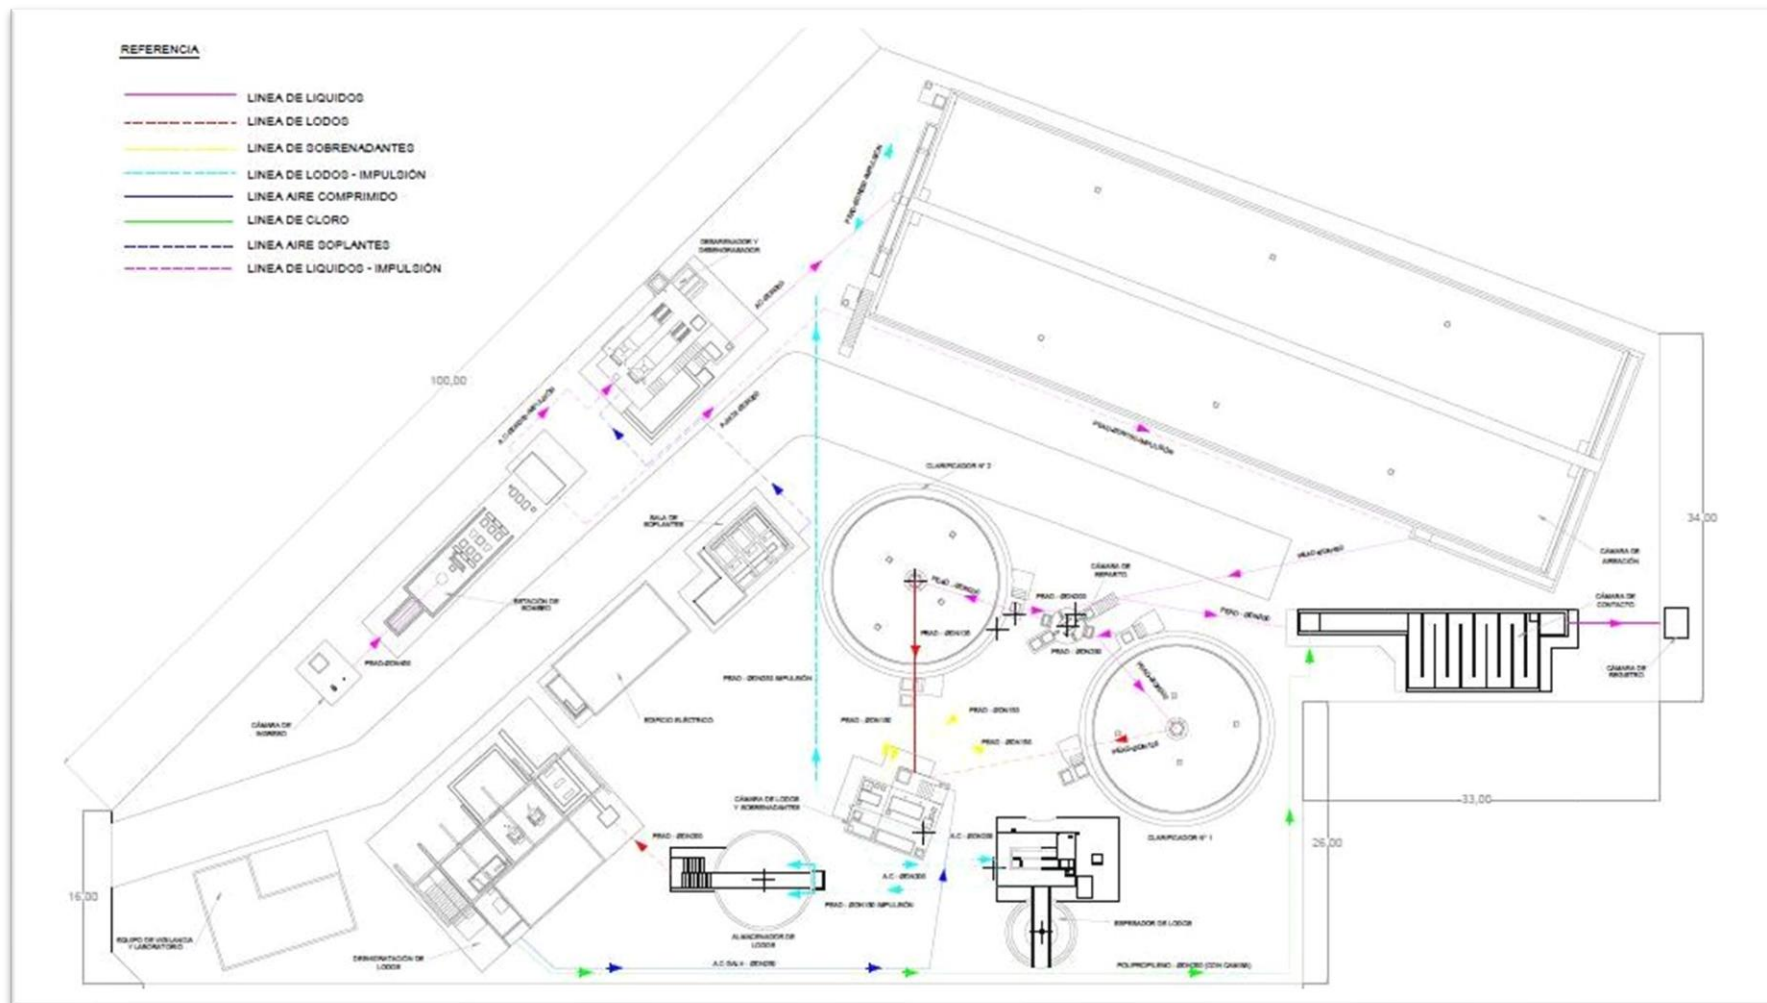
Vista en planta de la cañería de procesos. Fuente OPISU.
